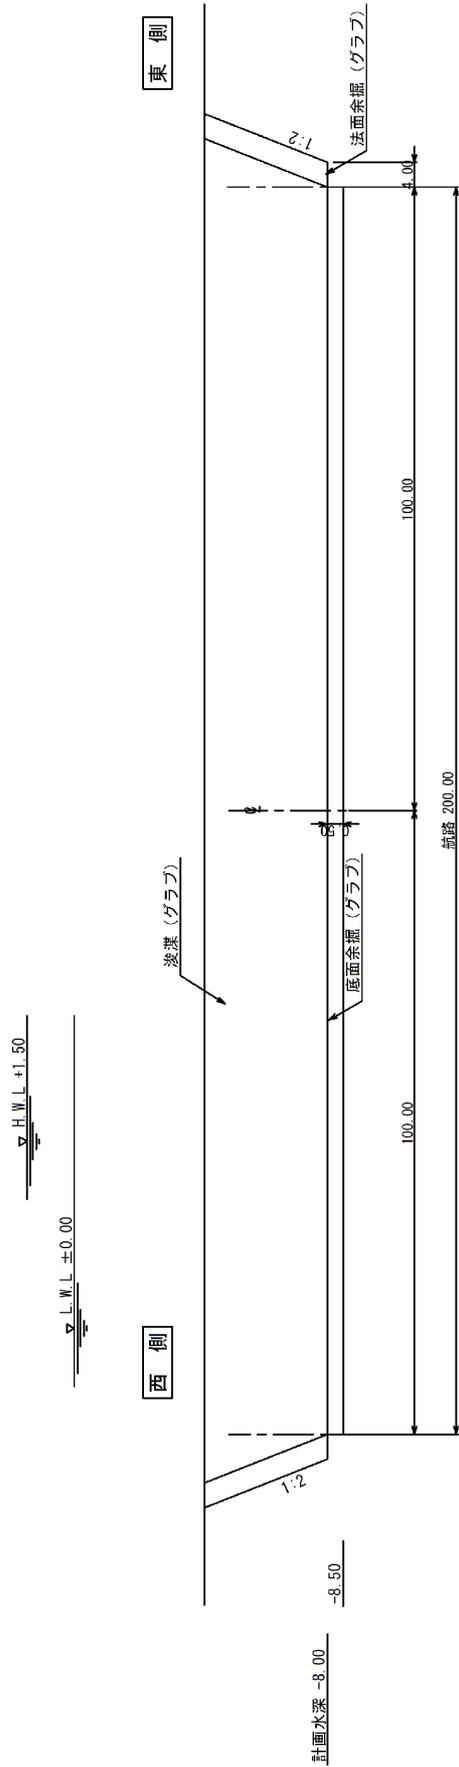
No.1 大洗港区_中央地区航路 (-8m) の断面図 (被災前)
